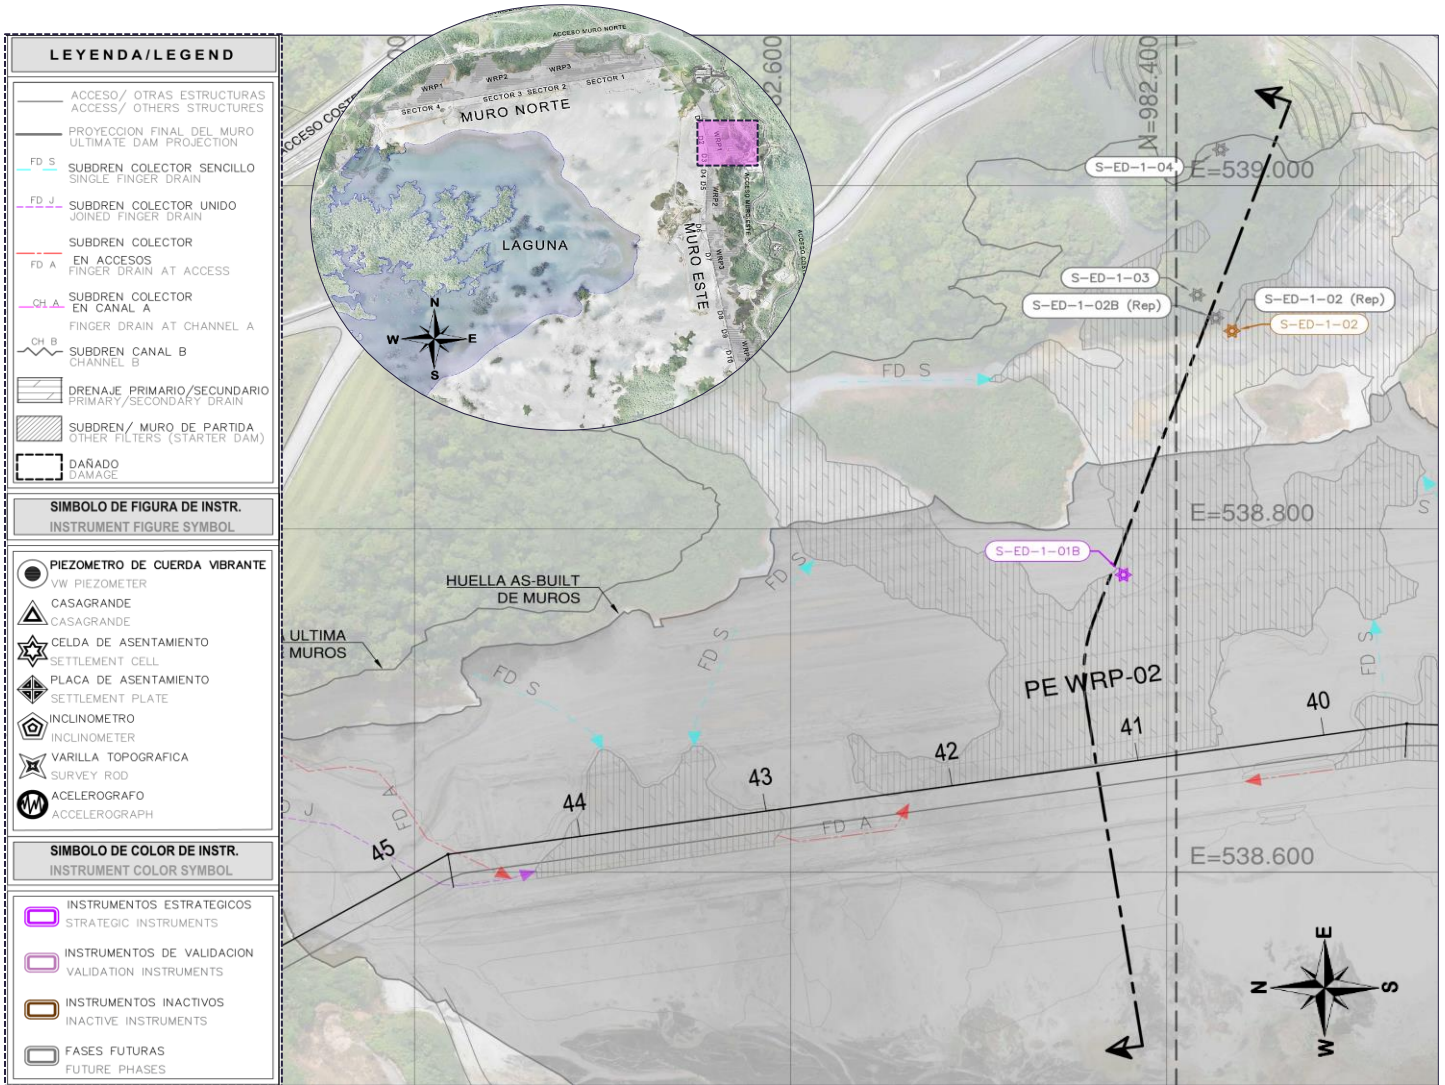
Vista de Planta en el Muro Este WRP1 con las Celdas de Asentamiento
